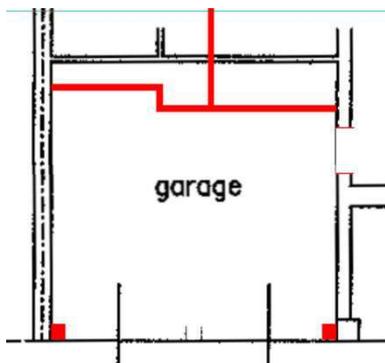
Estratto planimetria catastale del garage con indicazione delle difformità
